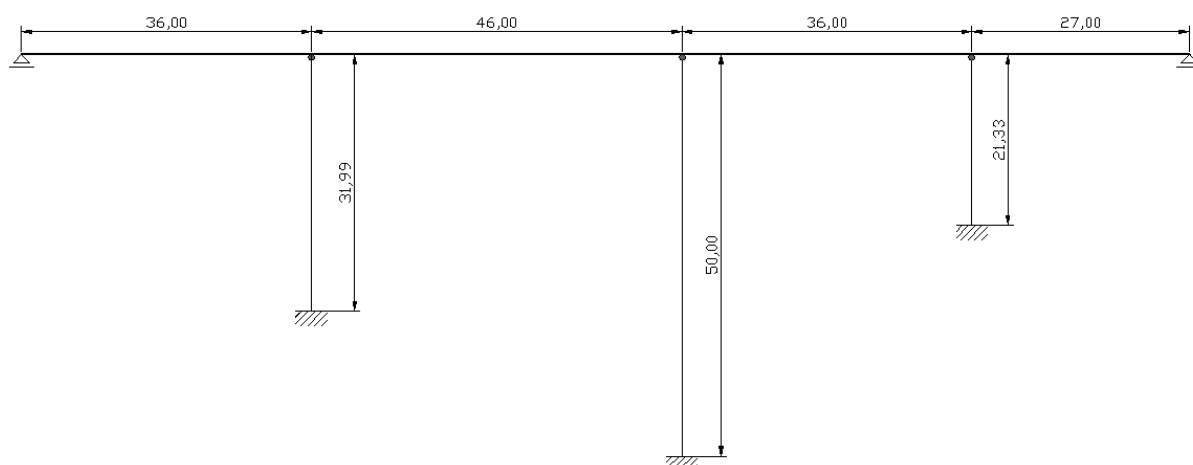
Modelo de cálculo adoptado para a estrutura.
